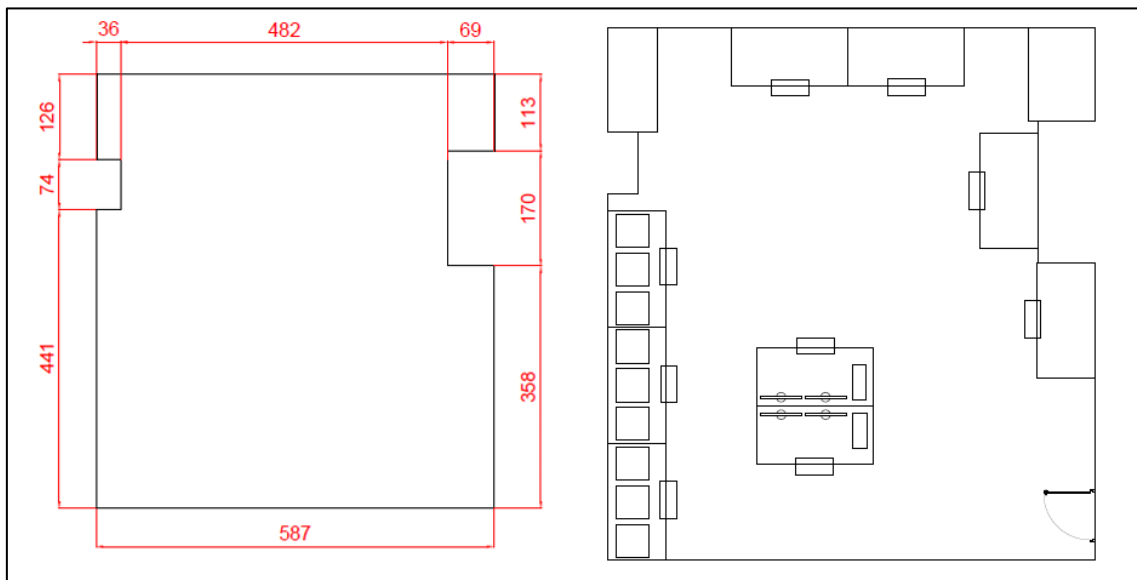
Planta del laboratorio de impresión 3D. Fuente: Elaboración propia.
